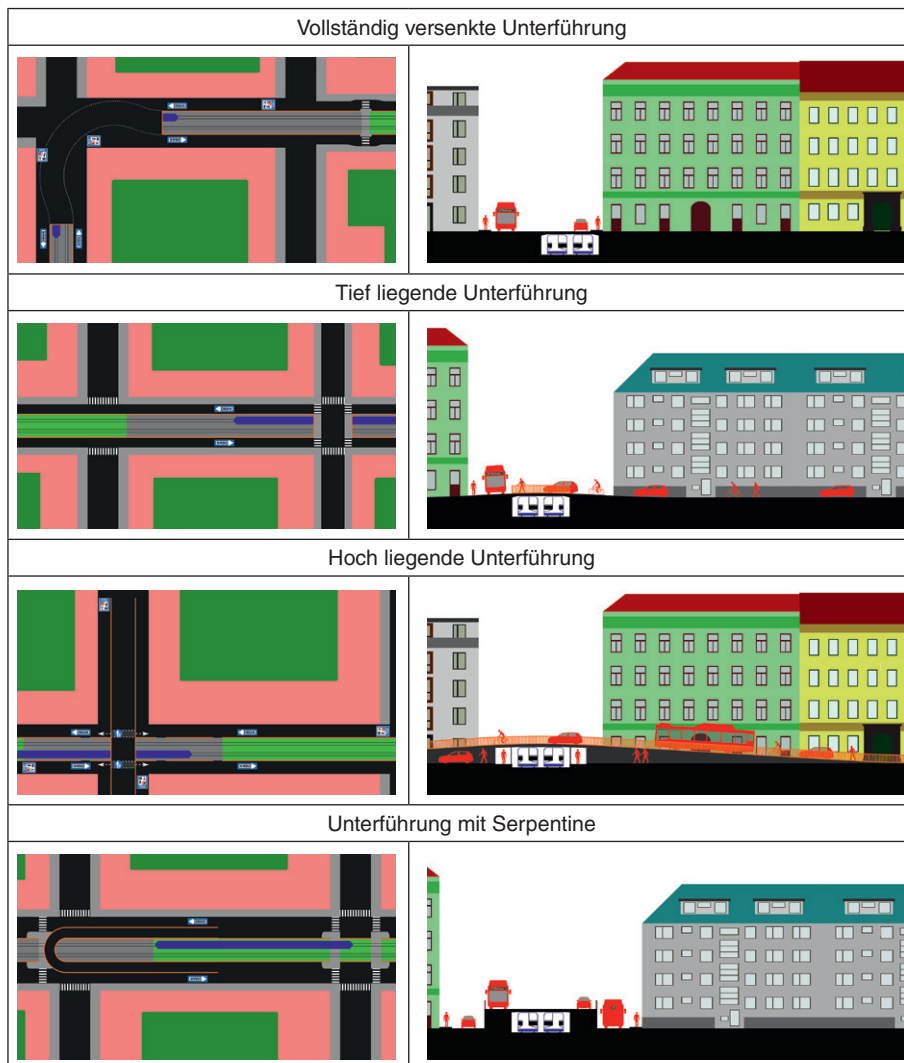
Grundriss- und Querschnittsdarstellungen der vier Grundtypen von LCRT-Unterführungsbauwerken.
